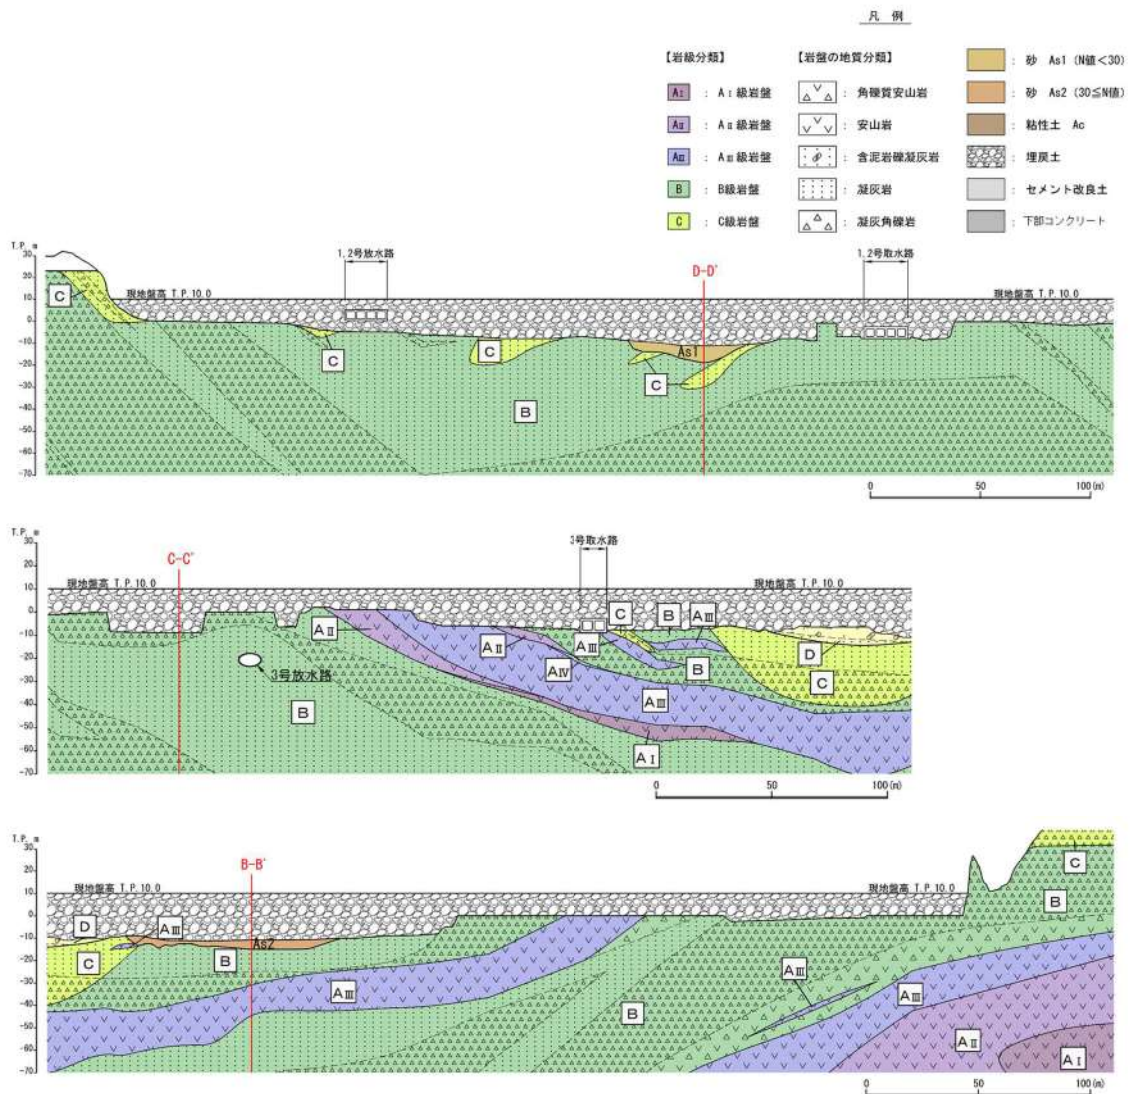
c.b-9 地質断面図 (A-A' 断面)
